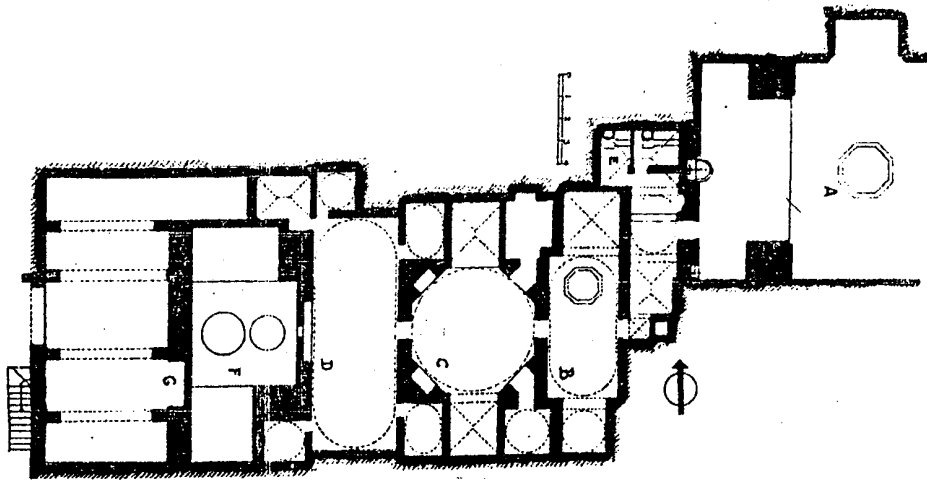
مسقط أفقي لحمام الطنبلي بالقاهرة
